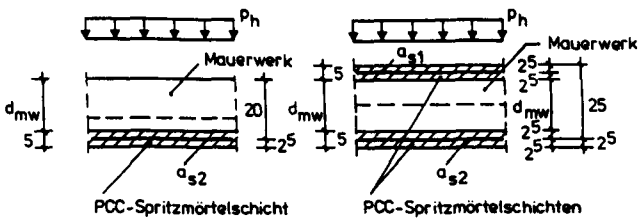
Horizontale Traglasten durch betonstahlbewehrte Ergänzungsschichten verstärkter, einachsig lastabtragender Mauerwerkswände: Variation des Verstärkungsumfanges
